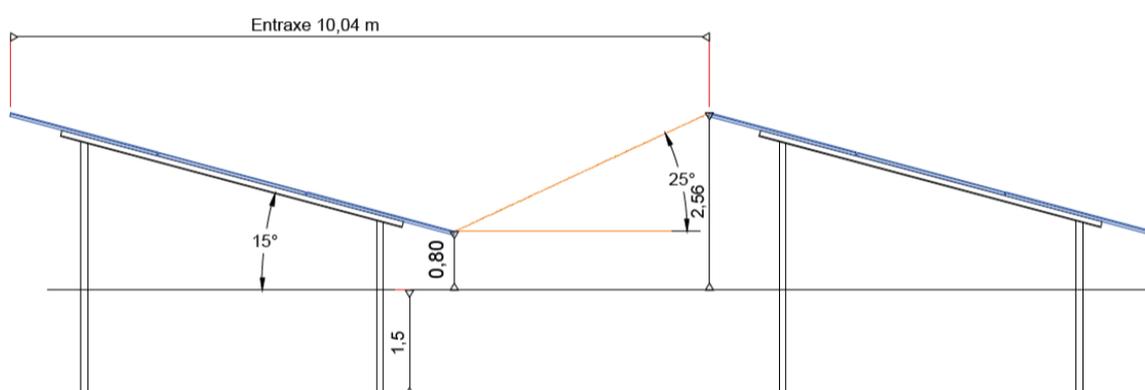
Coupe transversale des structures photovoltaïques sur pieux (dossier de permis de construire)
